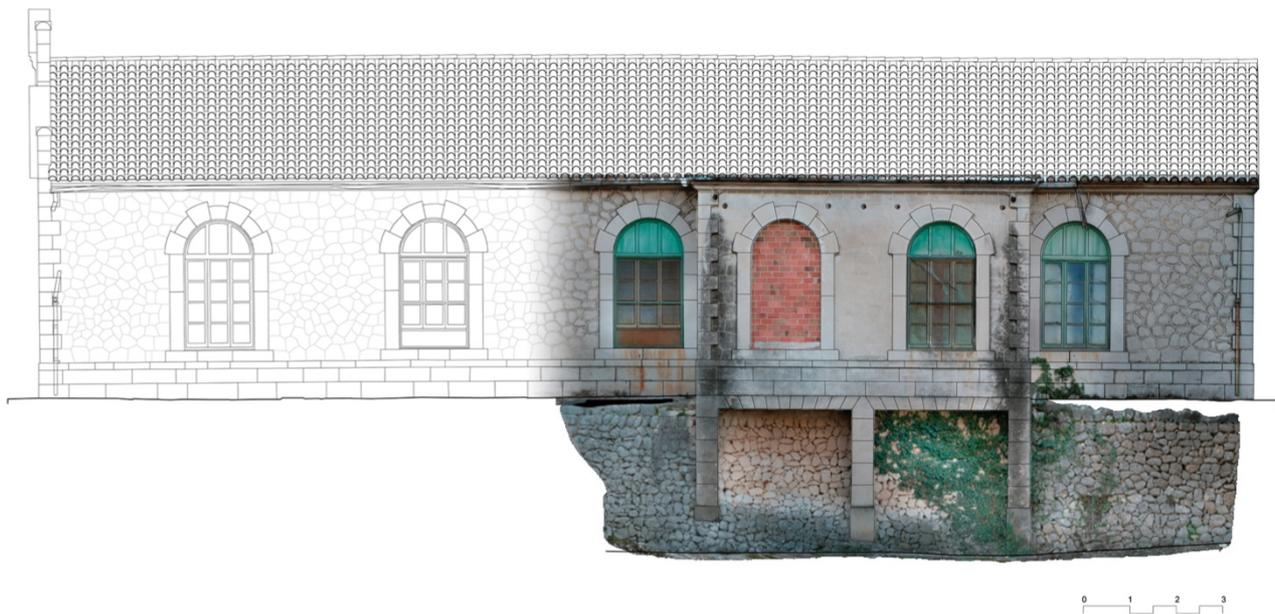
Ortofoto y modelo bidimensional. Fachada Este.
